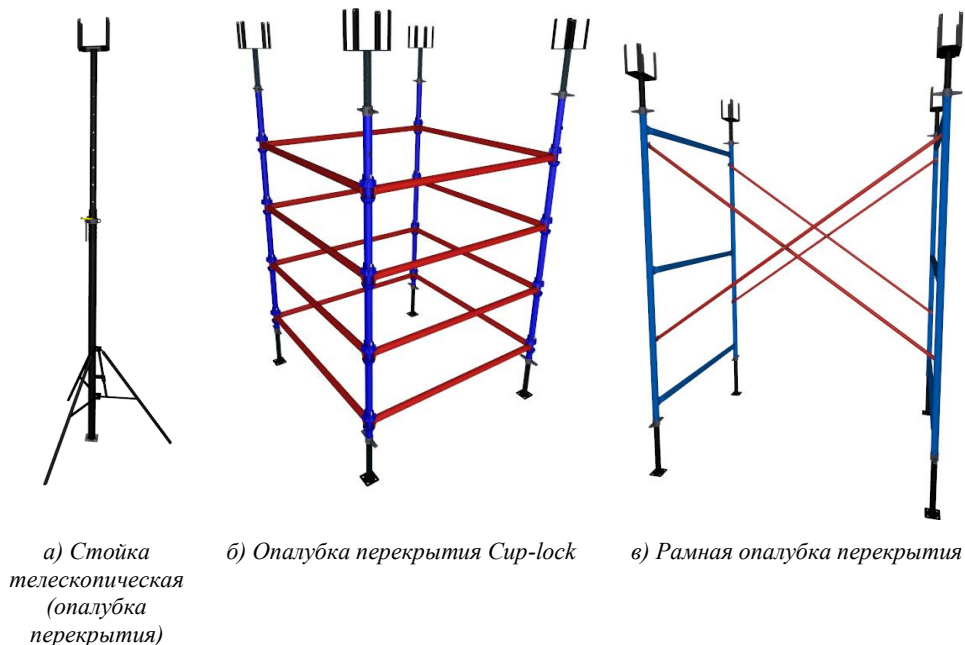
Наиболее распространённые конструкции опалубки перекрытия.
